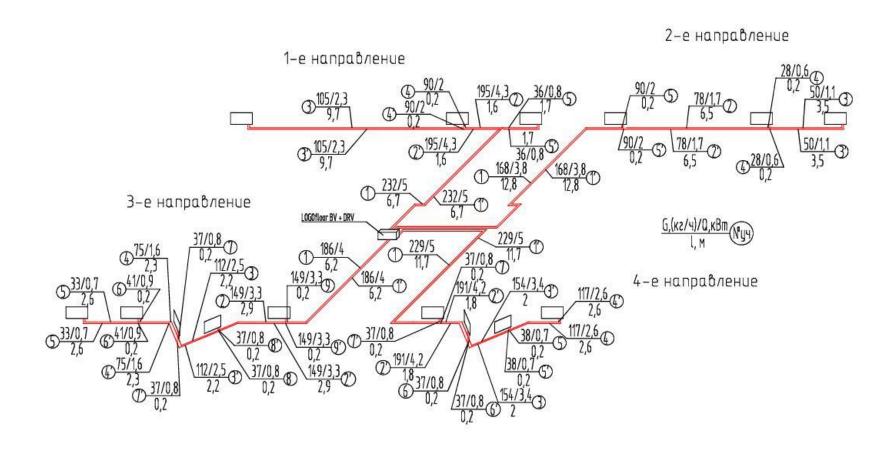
Расчетная схема поквартирной системы отопления (помещений подвала) БС-1,3
